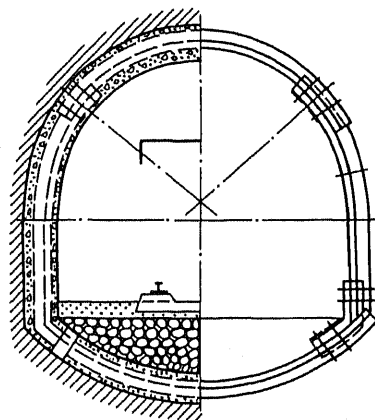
Конструкция замкнутой металлобетонной крепи МПКЗ конструкции Донгипрошахта
